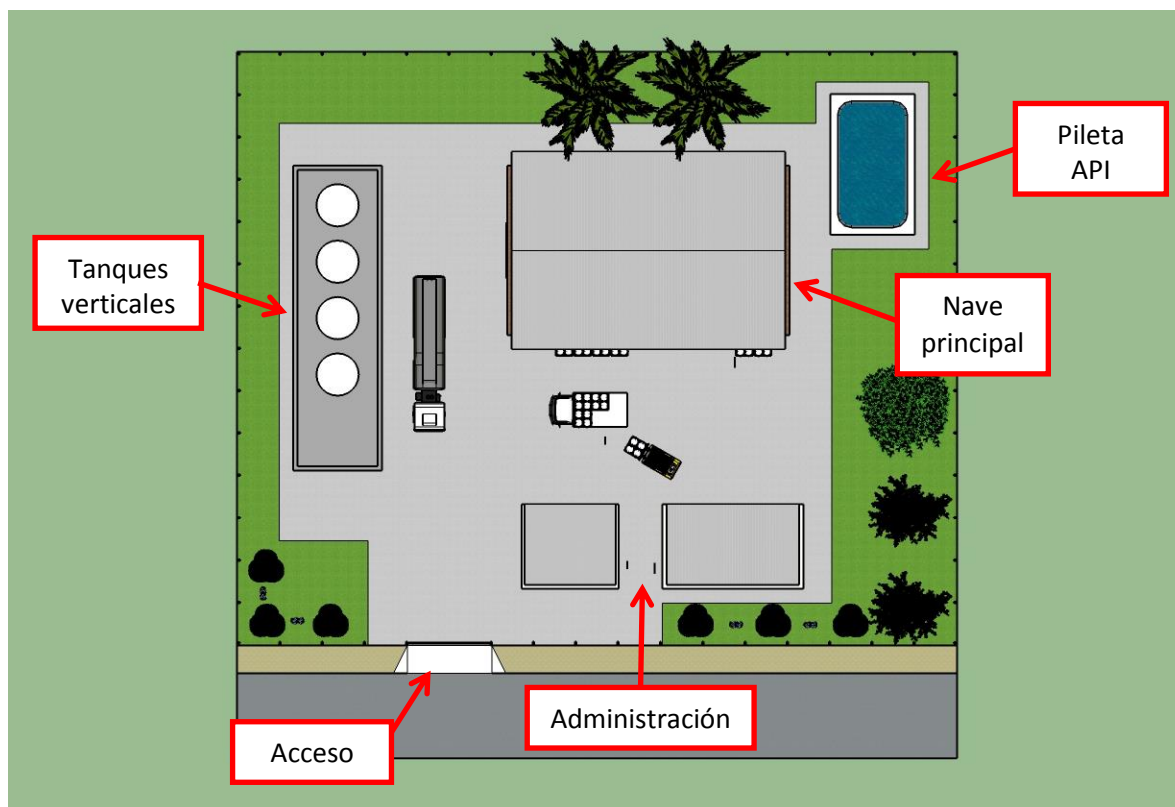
Vista de planta, donde se identifican la nave principal, tanques, zona administrativa y pileta API.
